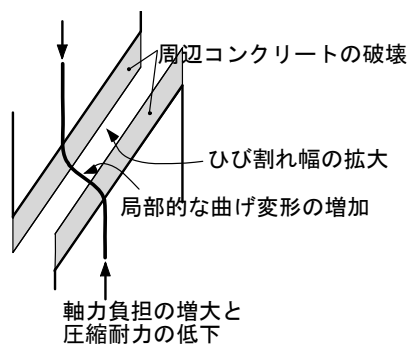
せん断ひび割れ面付近の挙動¹³⁾
